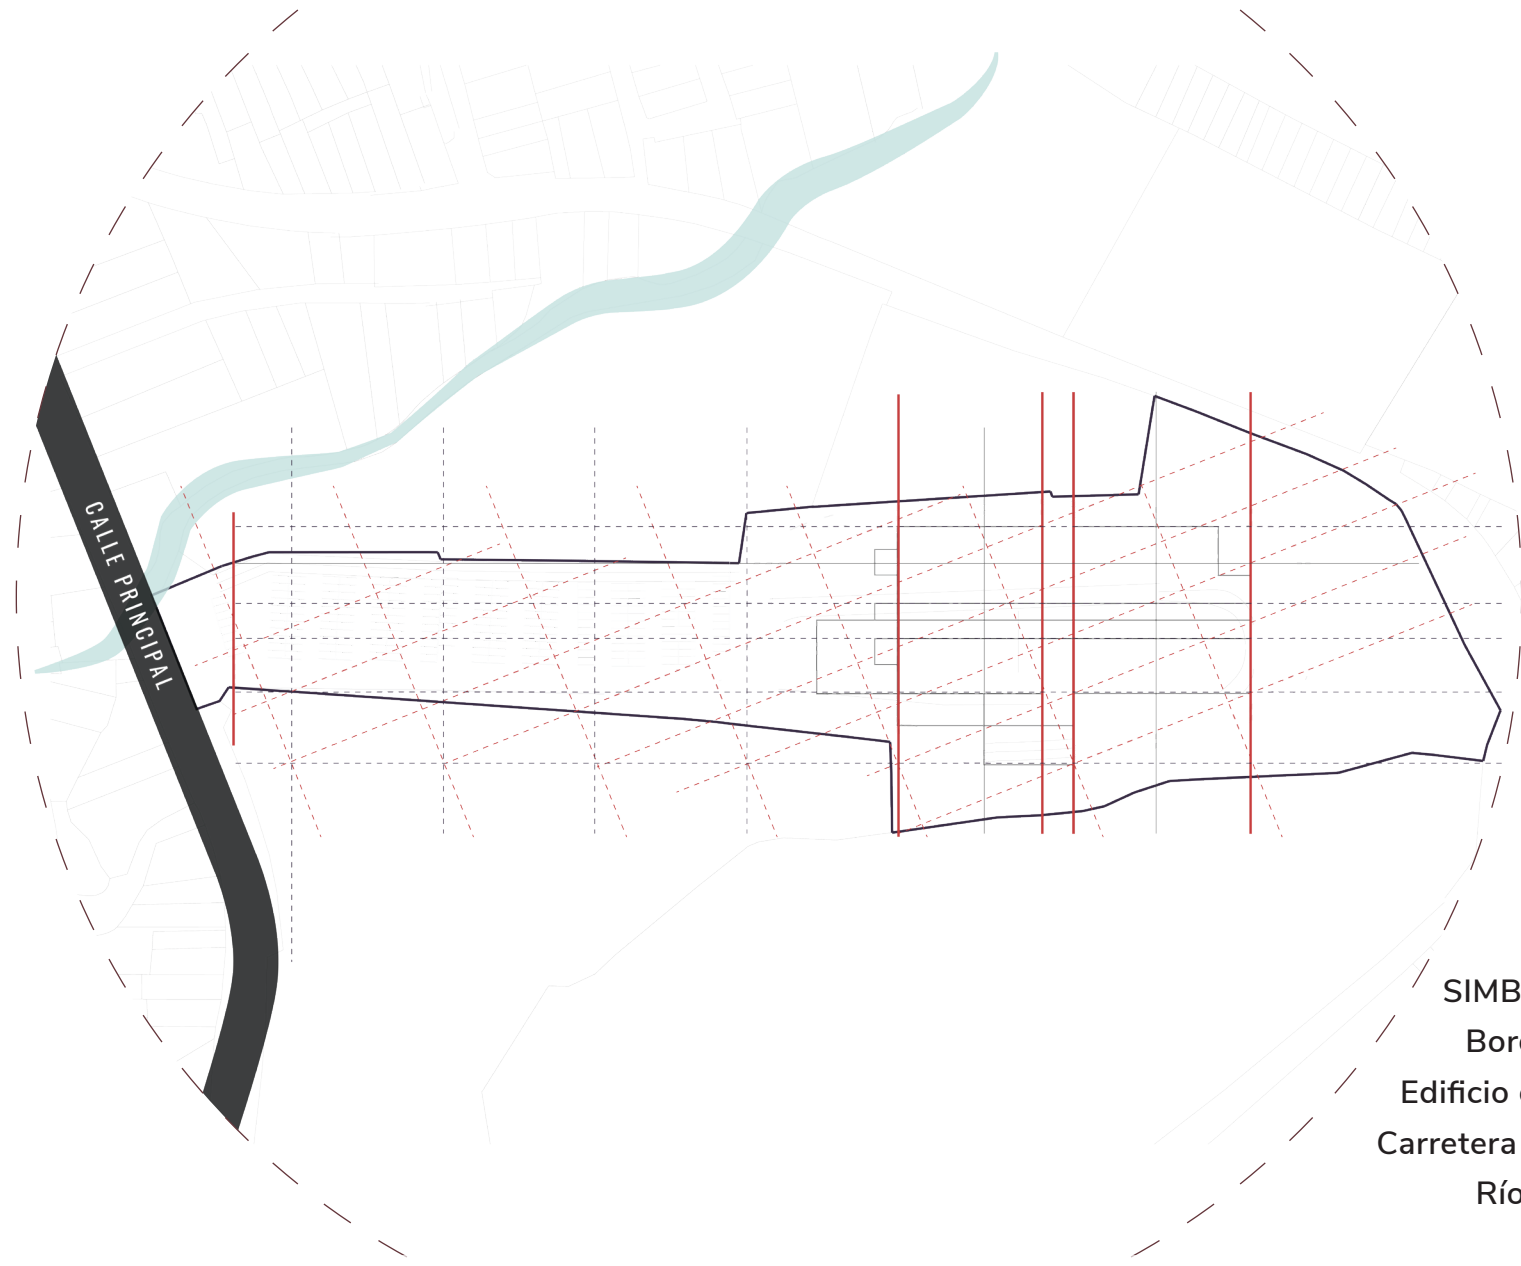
PLANTA DE ESPACIOS A INTERVENIR
